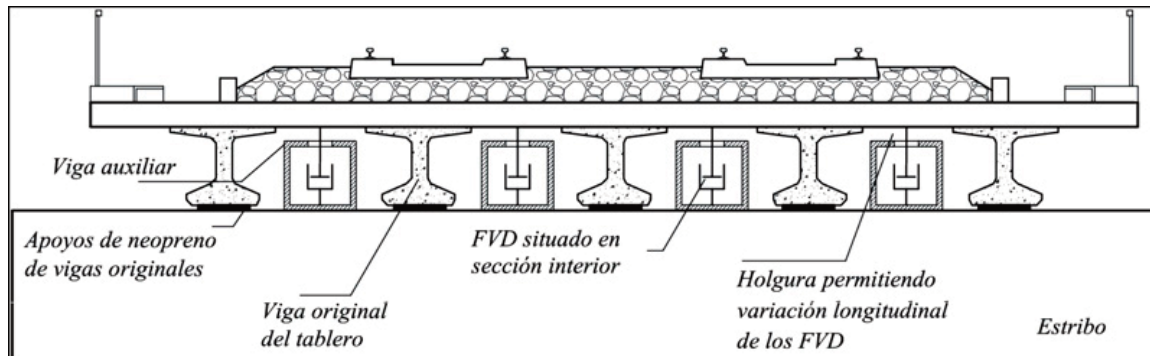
Sistema de reacondicionamiento propuesto instalado en tablero de vigas
